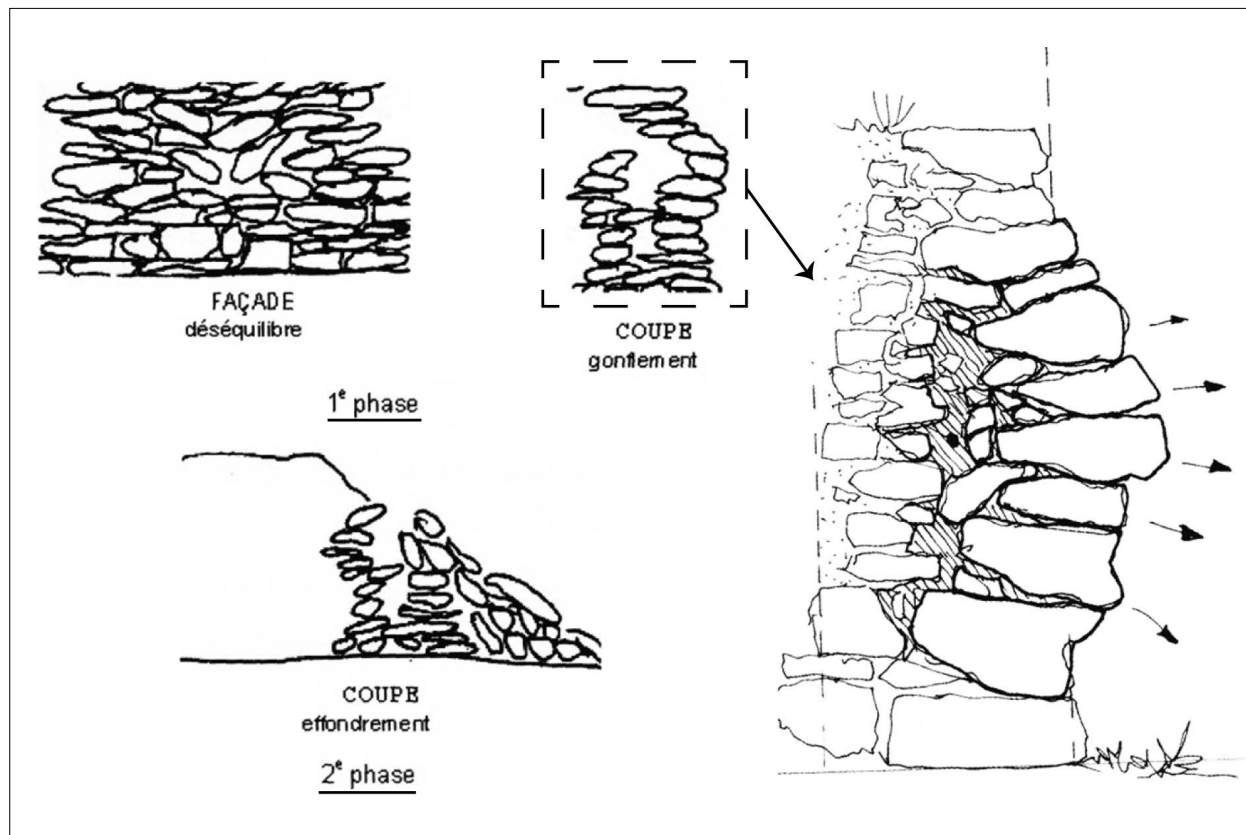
Dégénération d'un mur en pierre sèche, haut: première phase avec gonflement du mur (d'après CAPEB 2008), vue en coupe d'un ventre à droite, bas: seconde phase avec l'effondrement du mur de soutènement.
